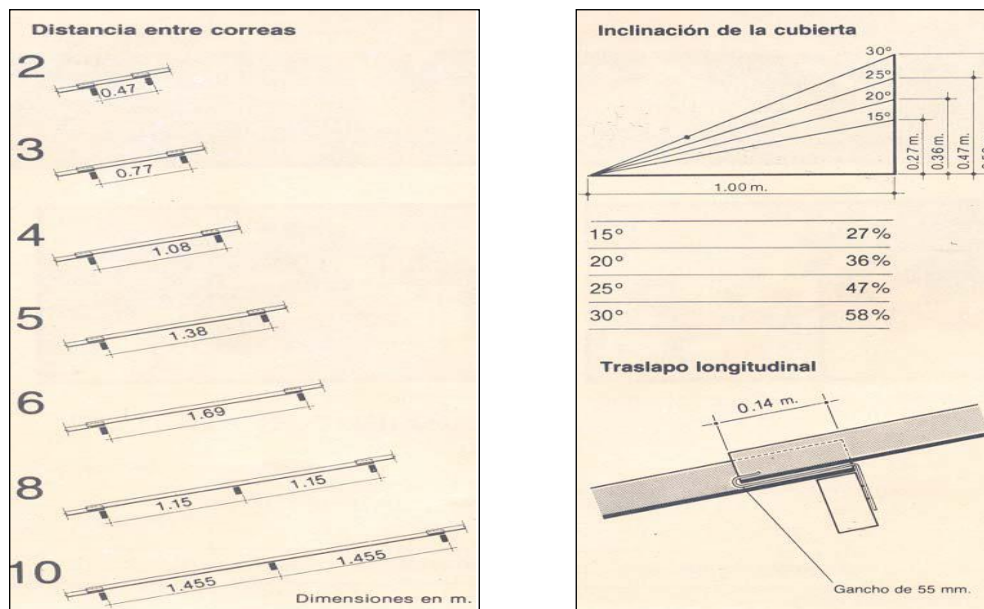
Dimensiones para la instalación de las cubiertas.
